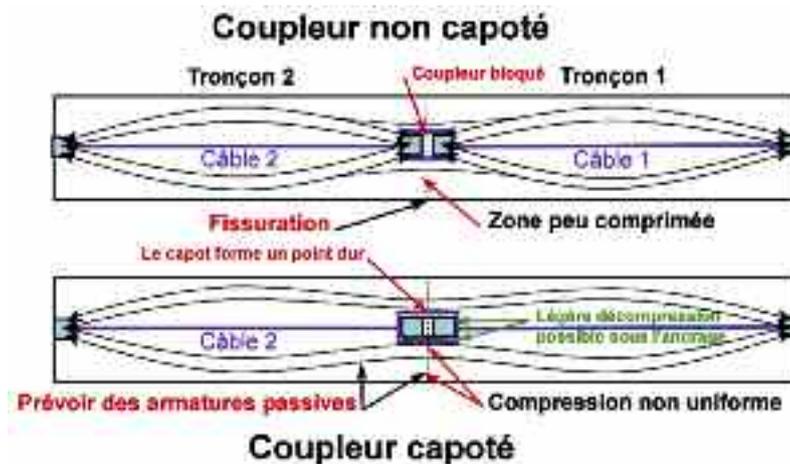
comportement d'un coupleur non-capoté et d'un coupleur capoté
